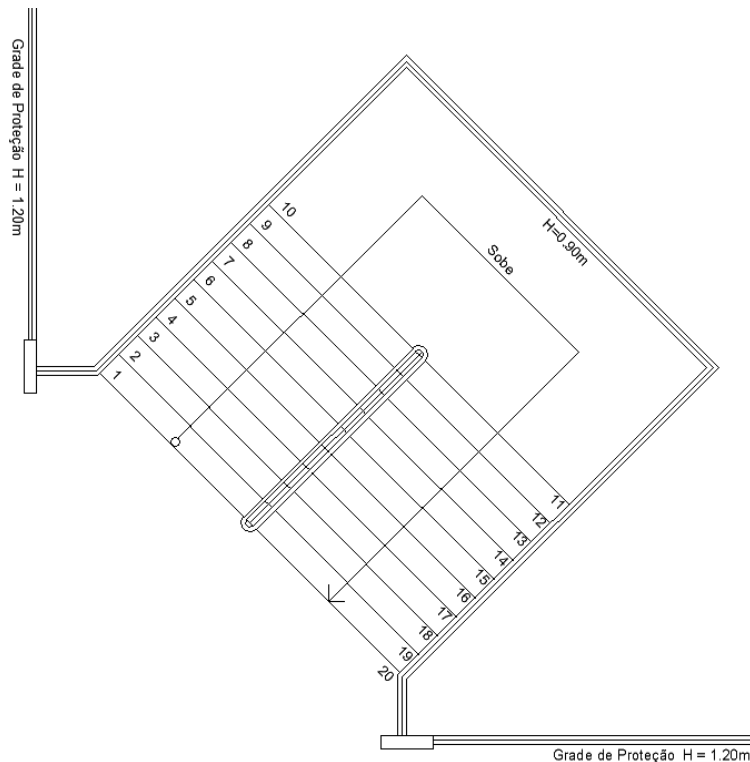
37 - Detalhe do projeto de arquitetura - Escada 4.
